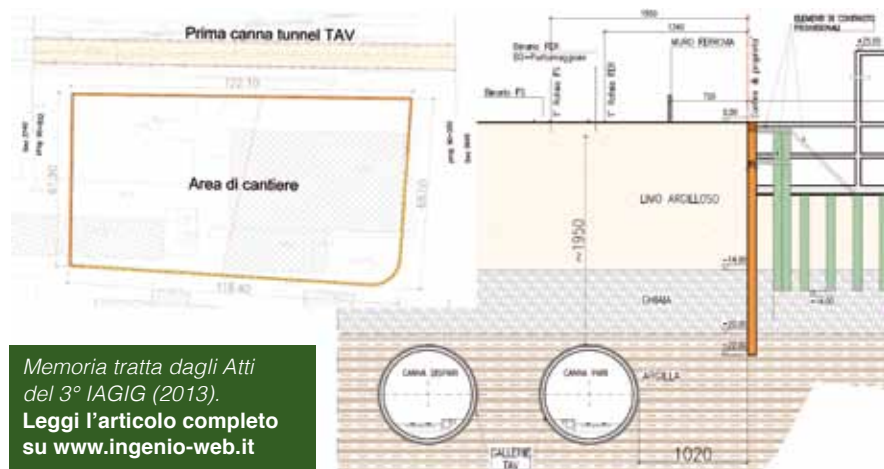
Posizione delle gallerie TAV rispetto alle opere in progetto
